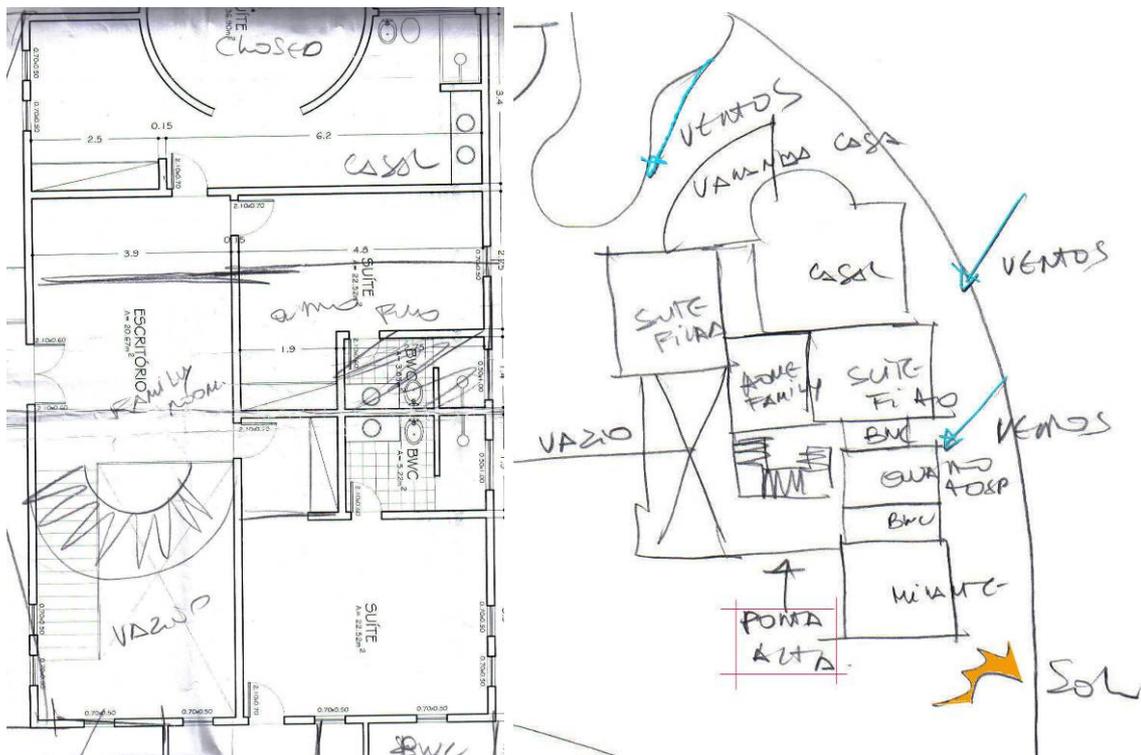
Planta baixa do pavimento superior (pré e pós reforma)
